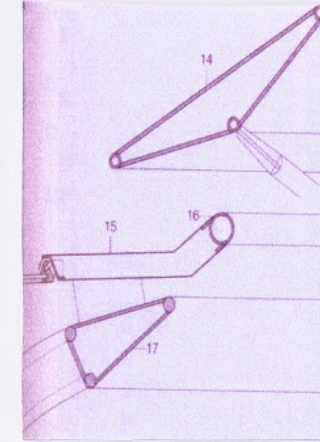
R.P.B. Atrium Çatı Strüktürü'nden Detay. (Detail, 1999, sayı.3-4)
